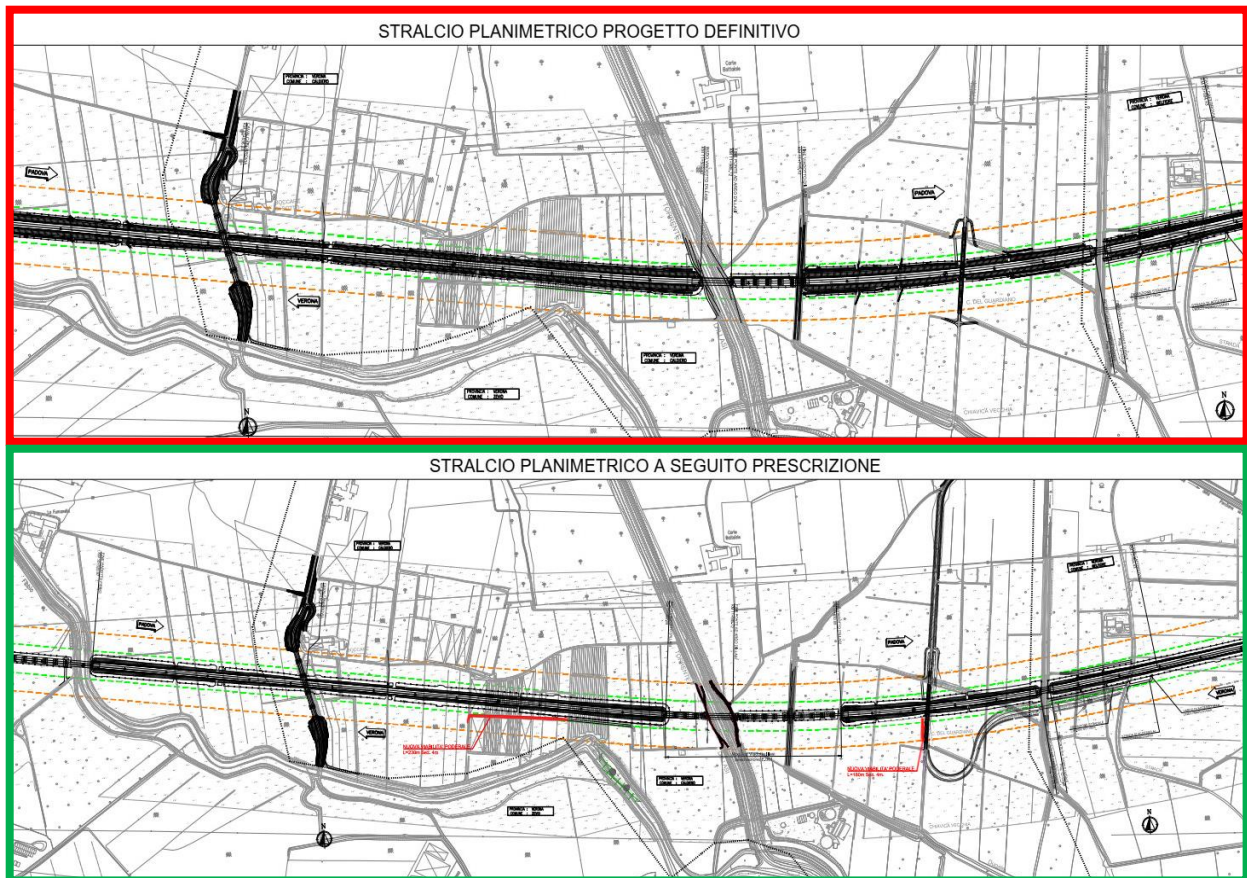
Confronto planimetria PD (rosso) PE (verde)
